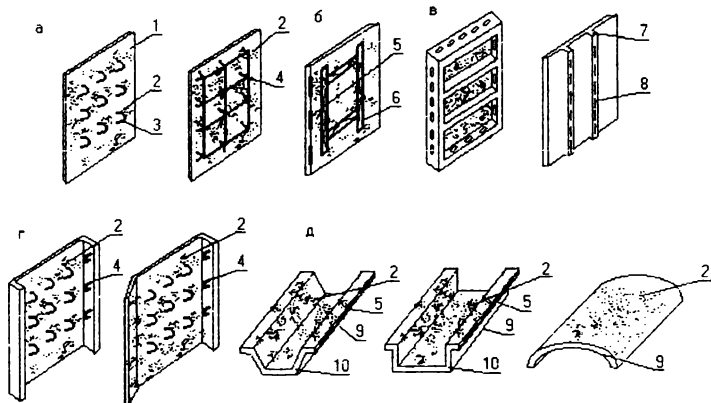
Виды железобетонных опалубочных элементов
